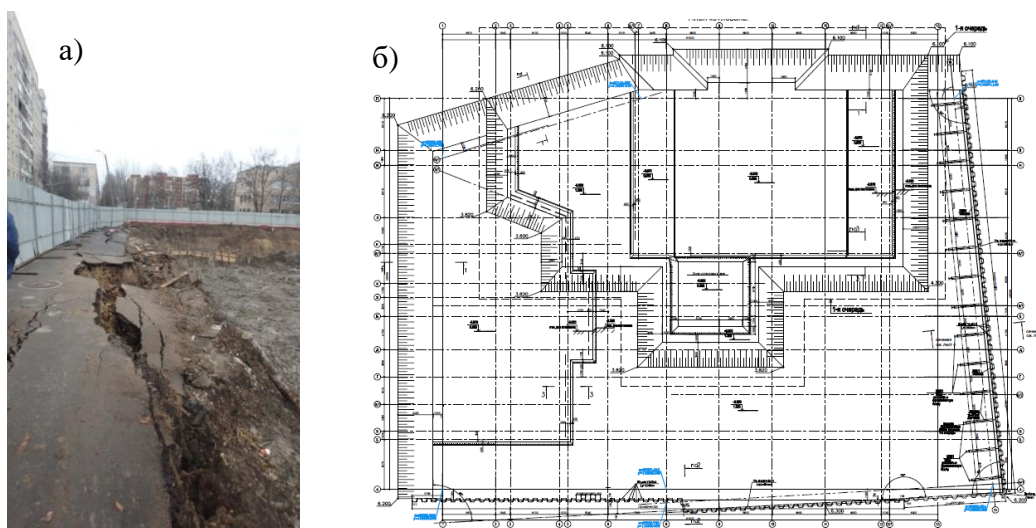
Опыт устройства котлована с естественными откосами под новое строительство в Купчино: а) вид бровки котлована после оползня; б) схема откопки котлована под строительство подземной части здания.
